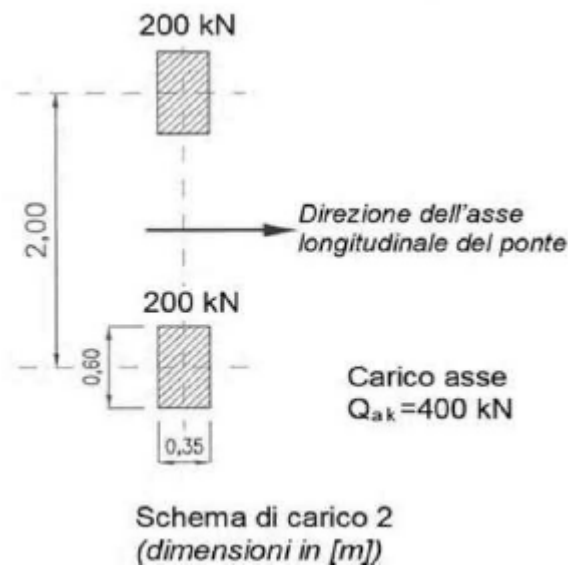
Schema di carico 2, estratto dalla Fig. 5.1.2
